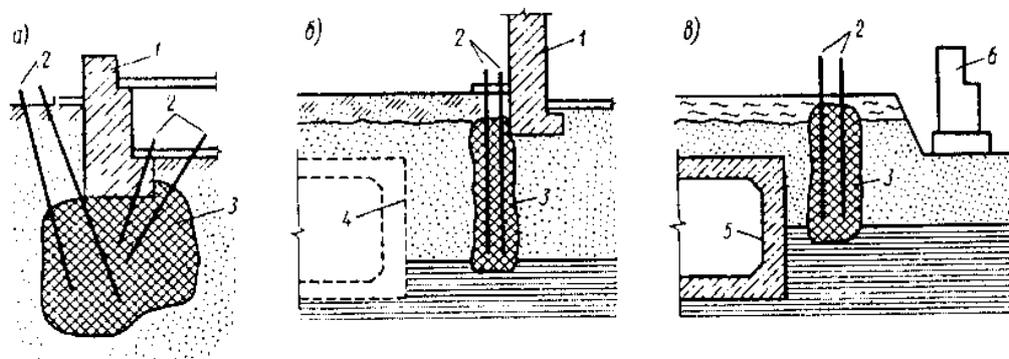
Схема закрепления методом силикатизации оснований фундаментов (а), защиты фундаментов зданий при строительстве подземных сооружений (б), при возведении зданий (в): 1 – фундамент; 2 – иньекторы; 3 – зоны закрепления; 4 – строящееся подземное сооружение; 5 – существующий тоннель; 6 – строящееся здание
